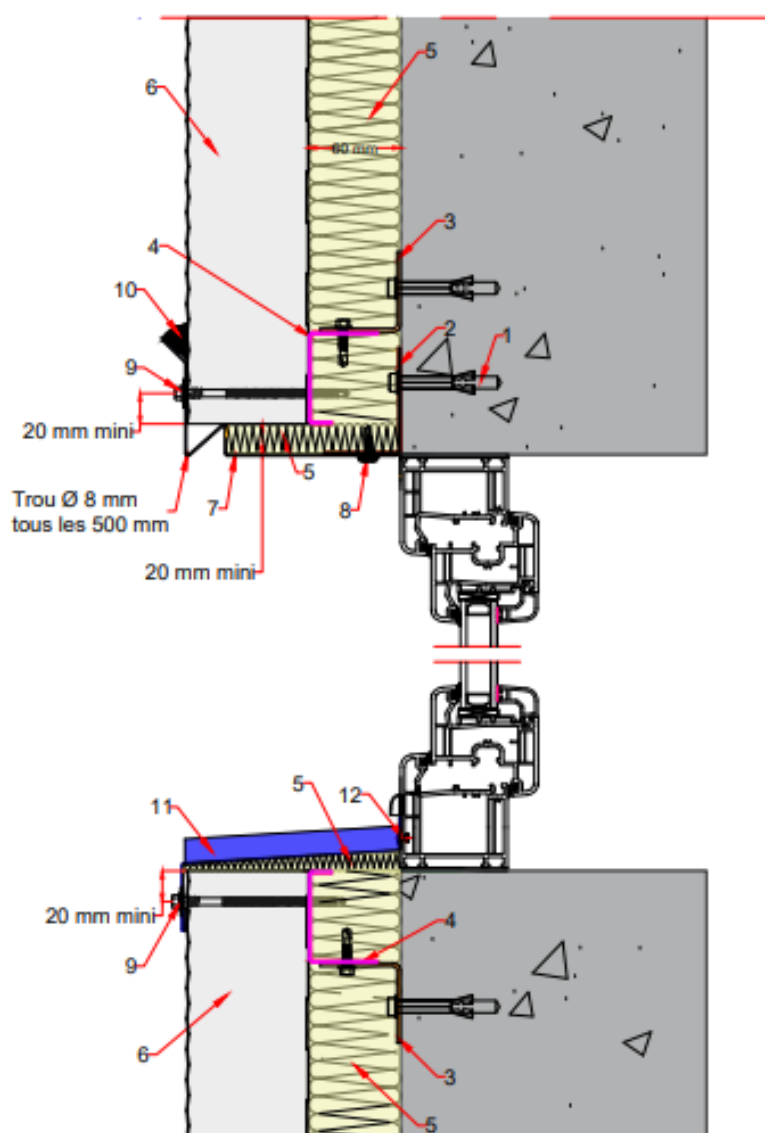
Menuiserie en applique intérieure – Linteau isolé – Panneaux entiers - Coupe verticale
